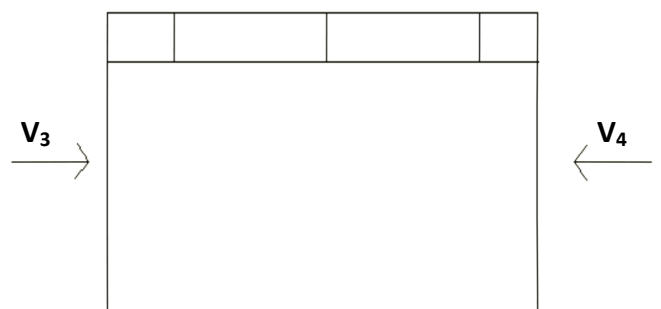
Vent sur la façade gauche et droite de la salle
